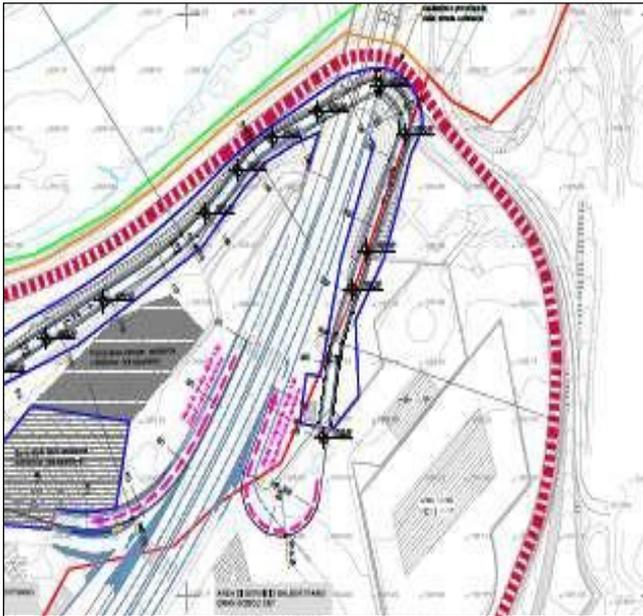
Viabilità di entrata in A32 dal Cantiere secondo il PRV
